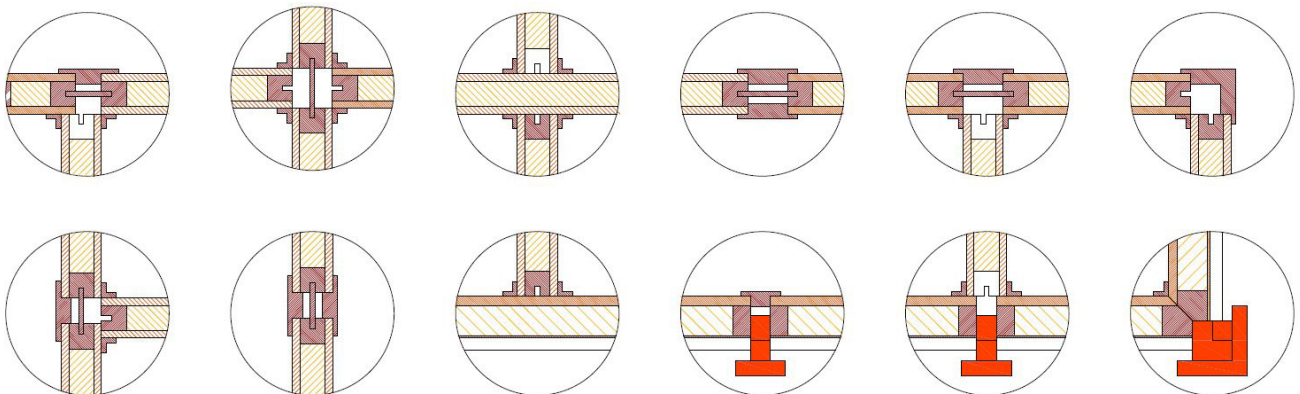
Diversas soluciones de encuentro en planta para las particiones interiores.
